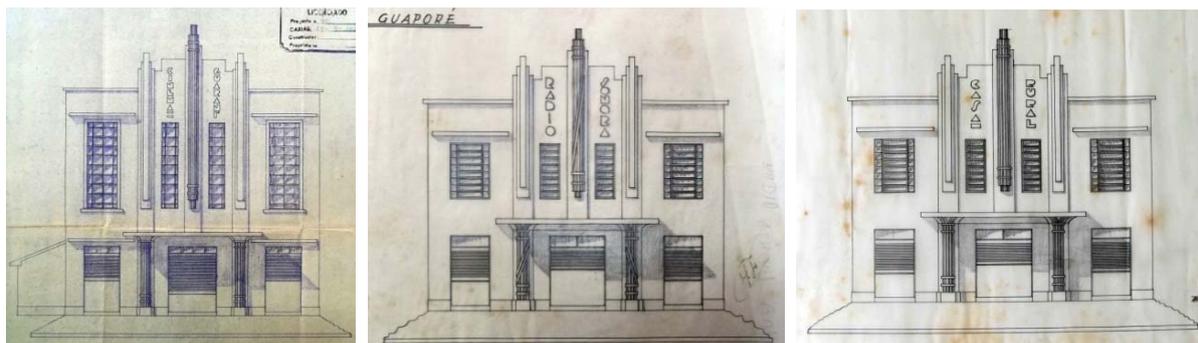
Fachadas do Cinema Guarany de Vacaria, Rádio Sonora e Casa Rural.
